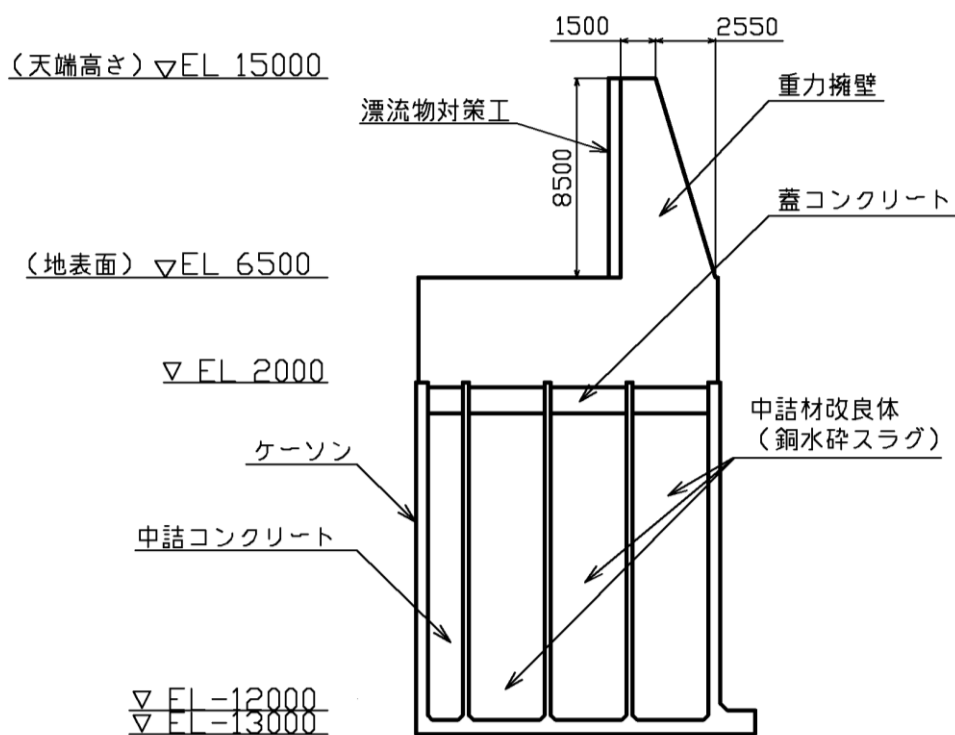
防波壁（波返重力擁壁）の横断面図（⑥-⑥断面）
